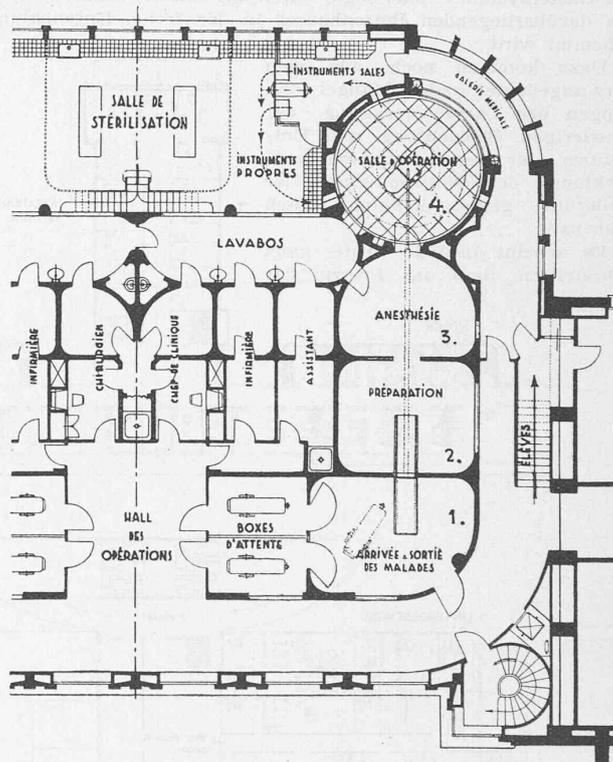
Operationsanlage im Spital zu Lille, Grundriss 1:240
